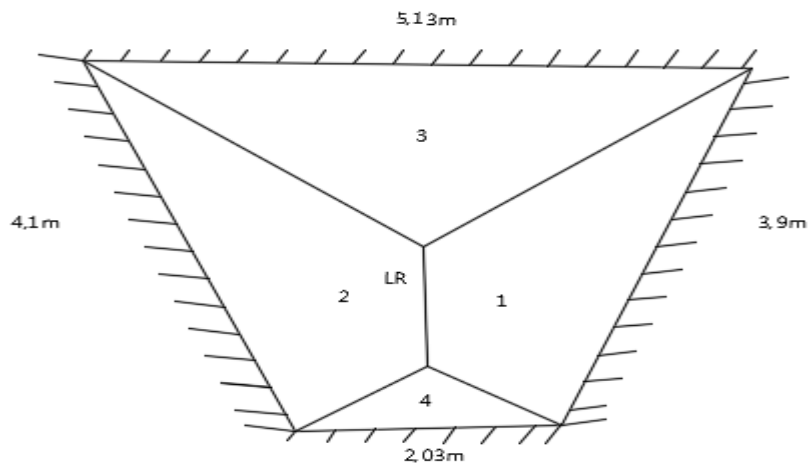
Dimension de la dalle pleine trapézoïdale.
